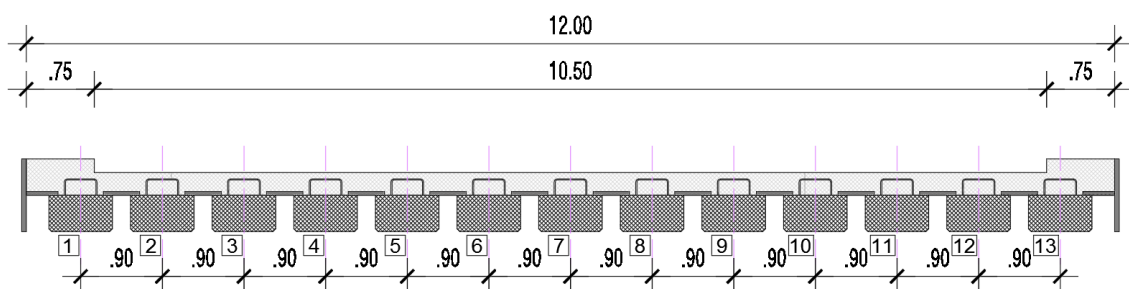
Sezione trasversale (sezione ortogonale all'asse stradale) struttura impalcato.
